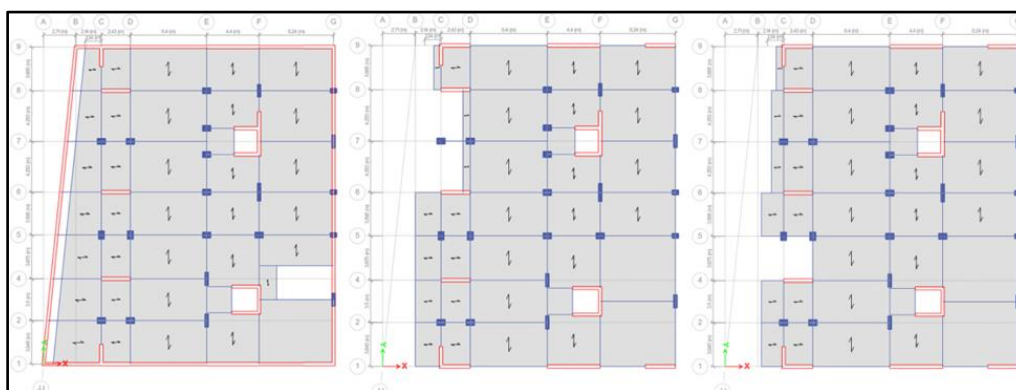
Vista en planta de techo de sótano, piso 1 y pisos típicos de la edificación.
